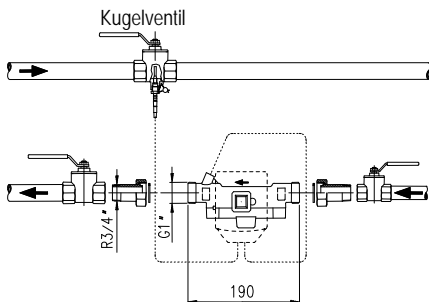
Beispiel für Einbindung mit Kugelventil und Zähler mit 190 mm-Armatur
